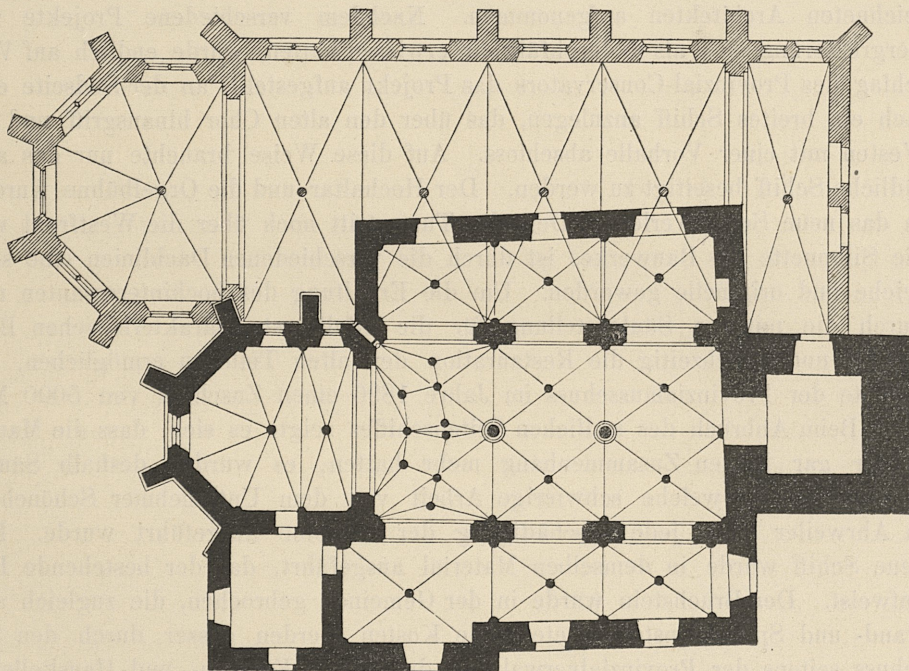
Wanderath. Grundriss der kath. Pfarrkirche nach der Erweiterung.
